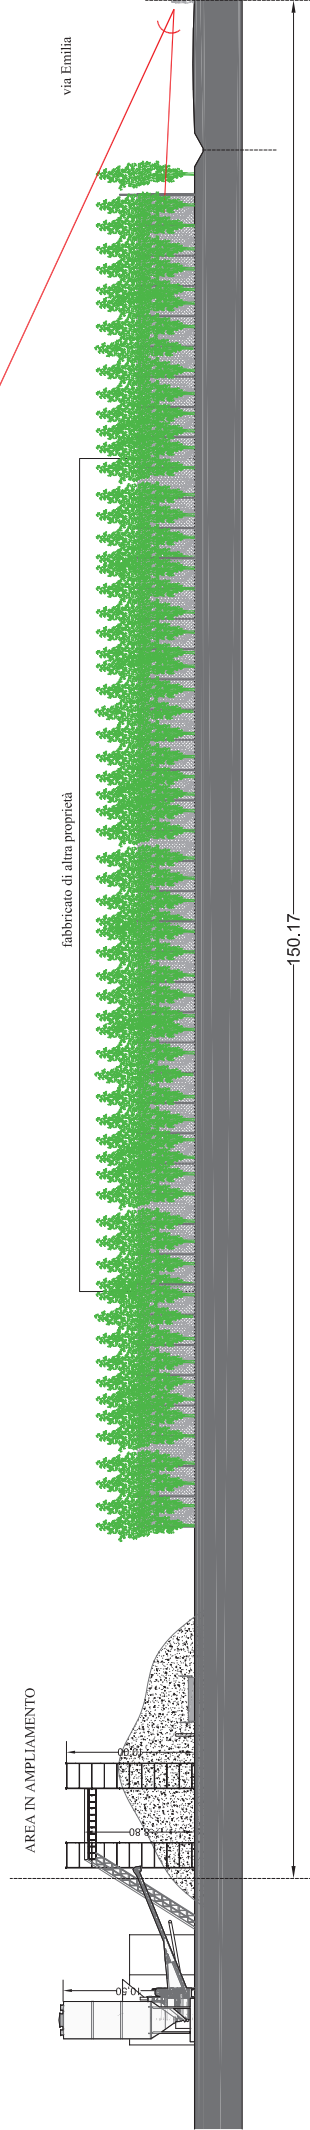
VISTA DELLO STABILIMENTO DALLA VIA EMILIA
